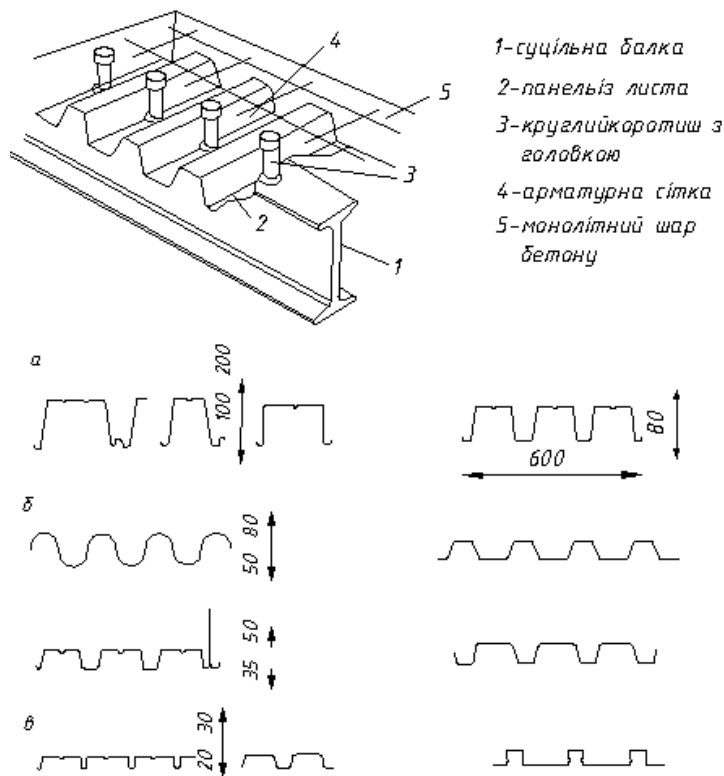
Схема перекриття зі сумісною роботою листа, бетону і балок перекриття.
